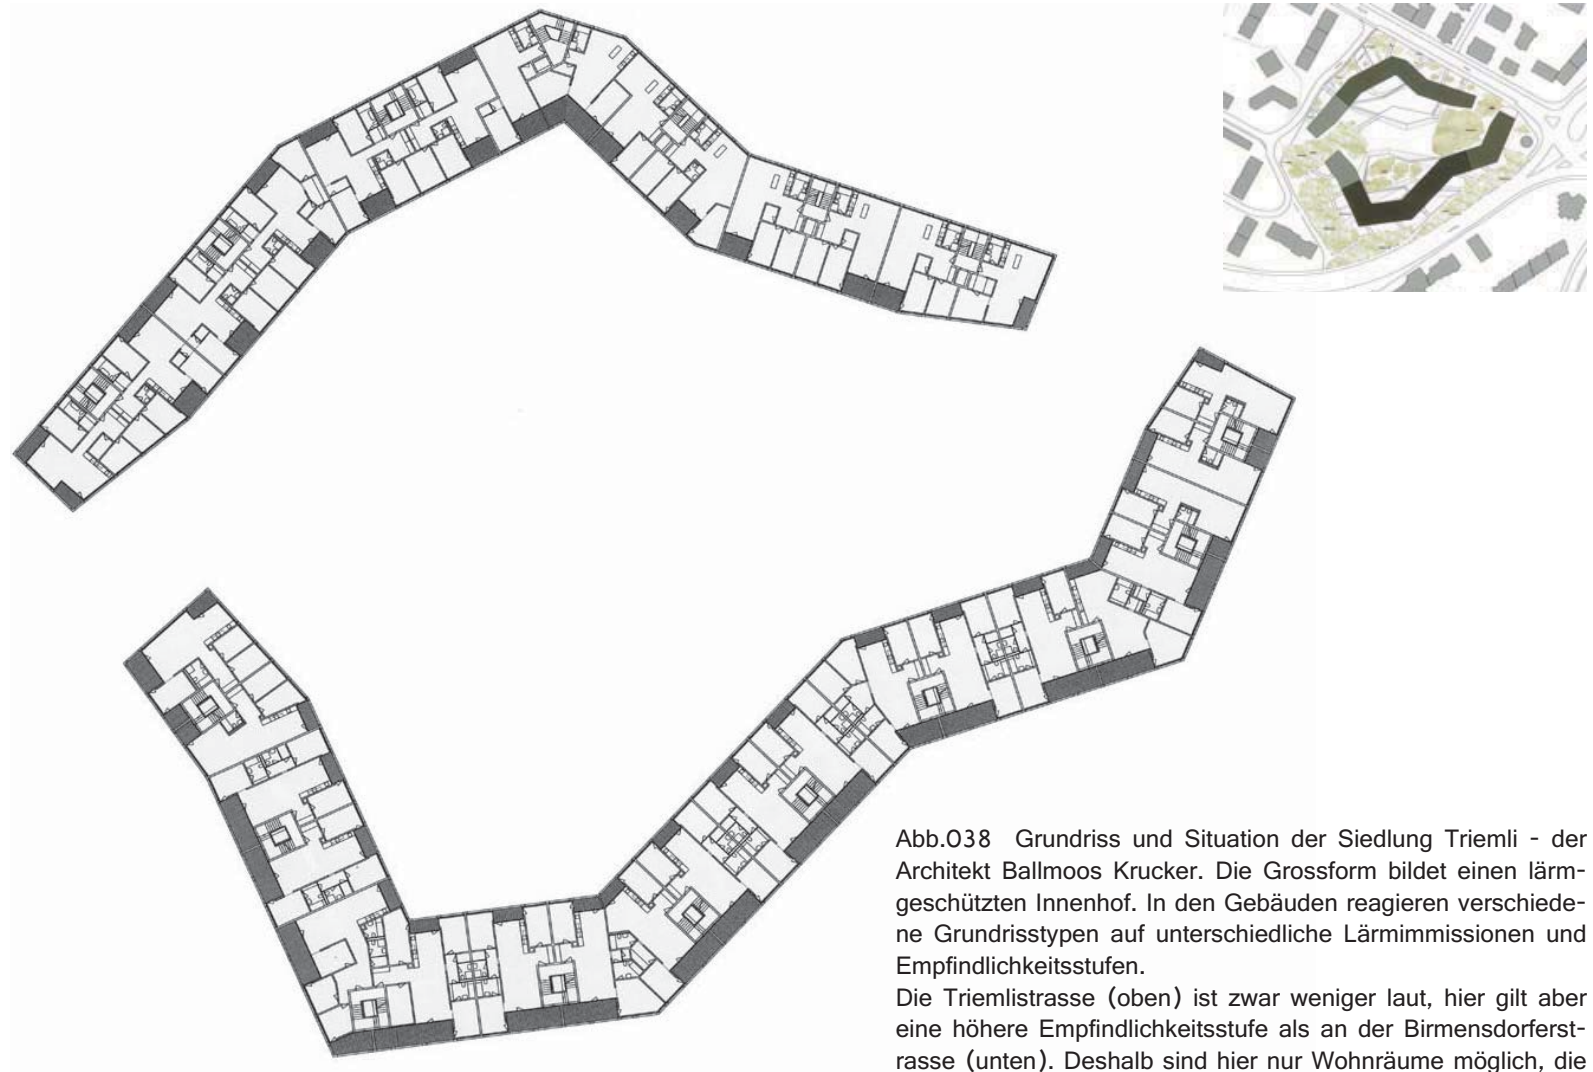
Grundriss und Situation der Siedlung Triemli - der Architekt Ballmoos Krucker. Die Grossform bildet einen lärmgeschützten Innenhof. In den Gebäuden reagieren verschiedene Grundrisstypen auf unterschiedliche Lärmmissionen und Empfindlichkeitsstufen.
